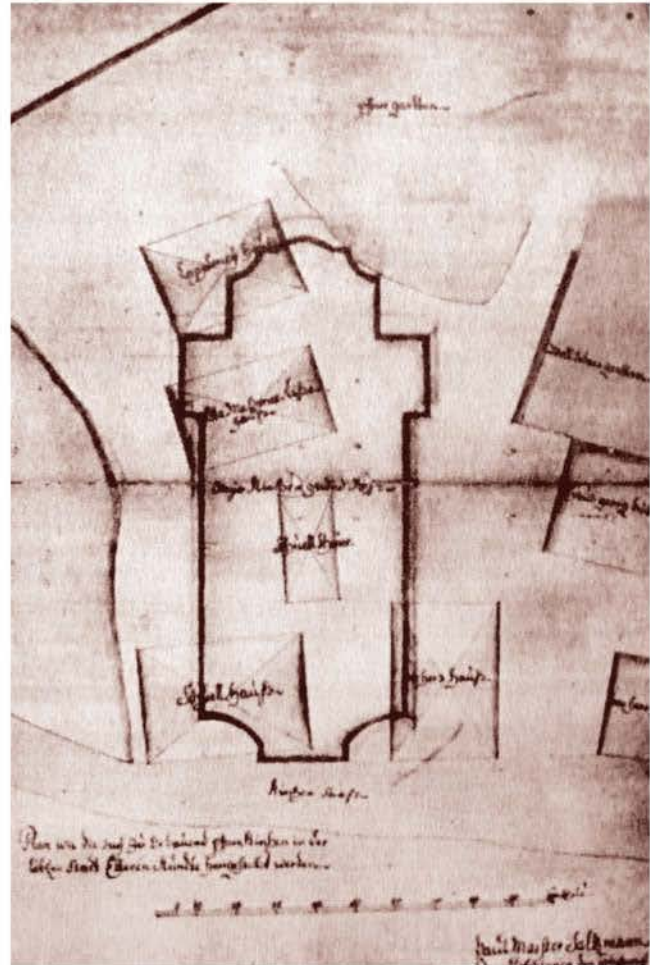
Lageplan für den Neubau der Pfarrkirche von Franz Joseph Saltzmann vom 10. Juni 1764, darin aufgeführt das Schulhausgebäude. (Stadtarchiv Ettenheim: Urkunden Nr. 9 (Fasz. Kirchenbau, Plan 4)
